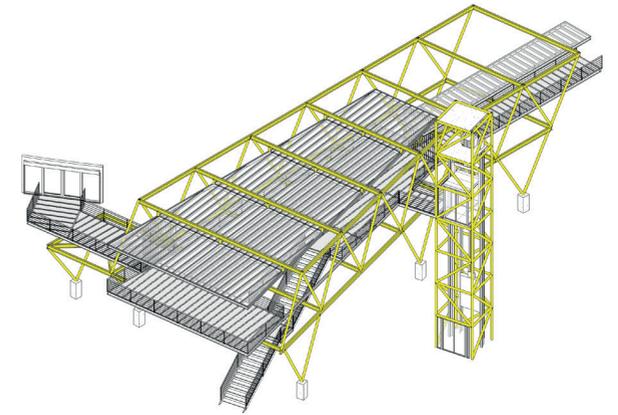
Plano ubicación mediador traspaso entre exteriores divergentes A. (2021). Planimetría. Elaboración propia.
